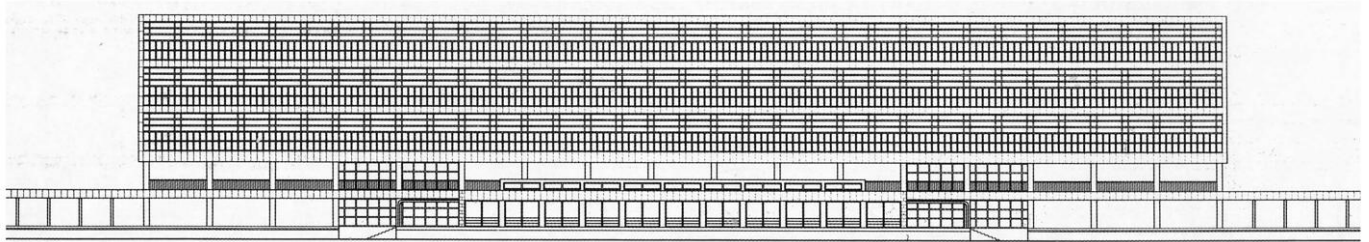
prospetto nord-est, lato mare, 1938, Archivio Vaccaro
